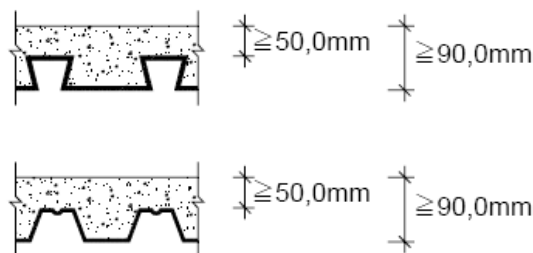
Espessura da laje. (“Lajes mistas,” n.d.)
